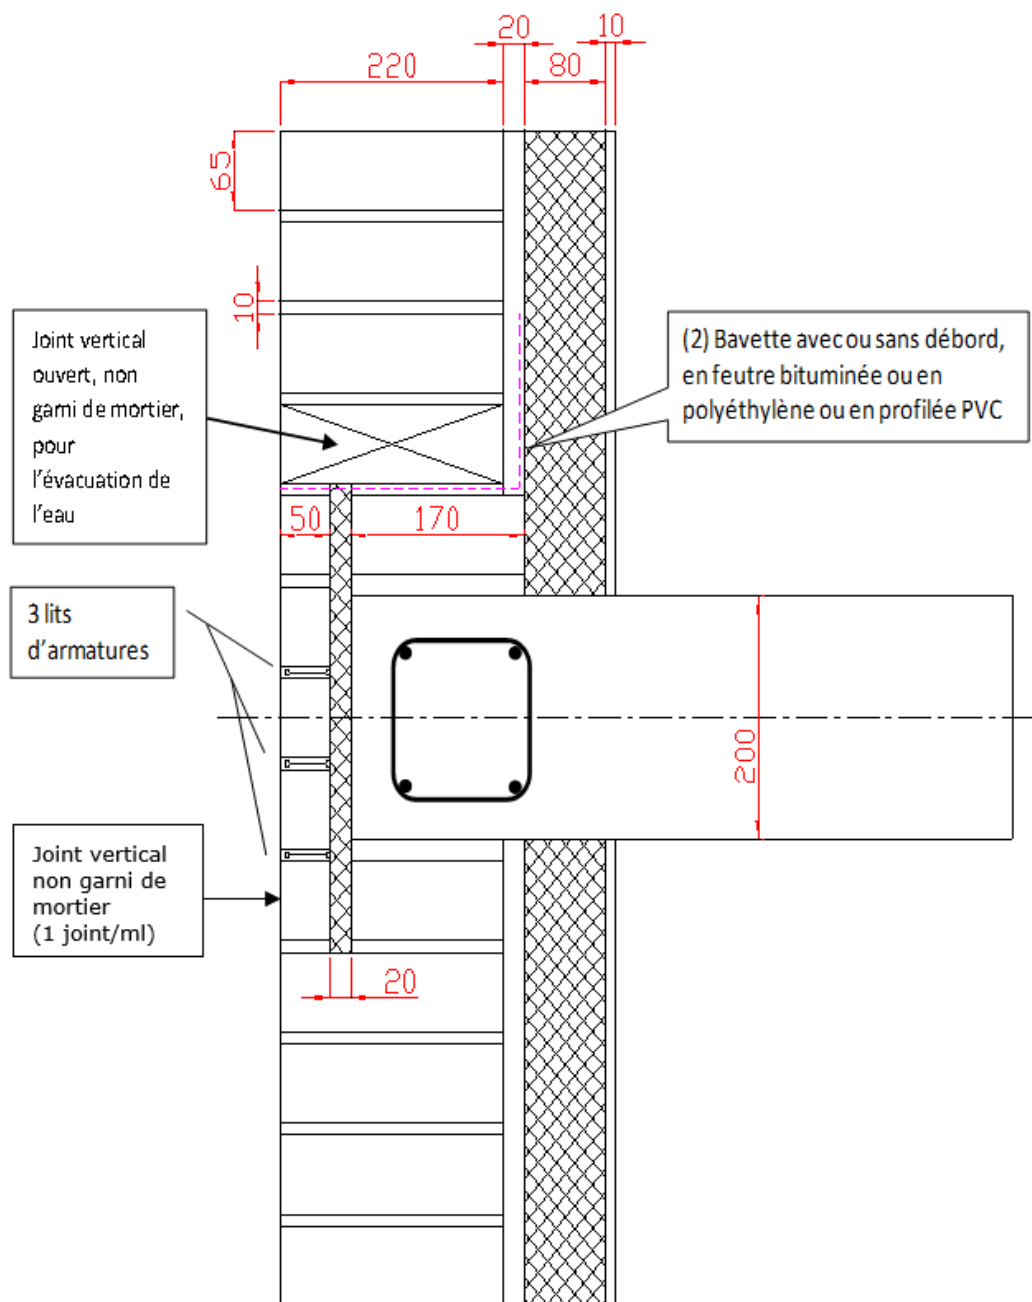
Mur de type IIa avec about de plancher constitué de 5 rangées de mulots
